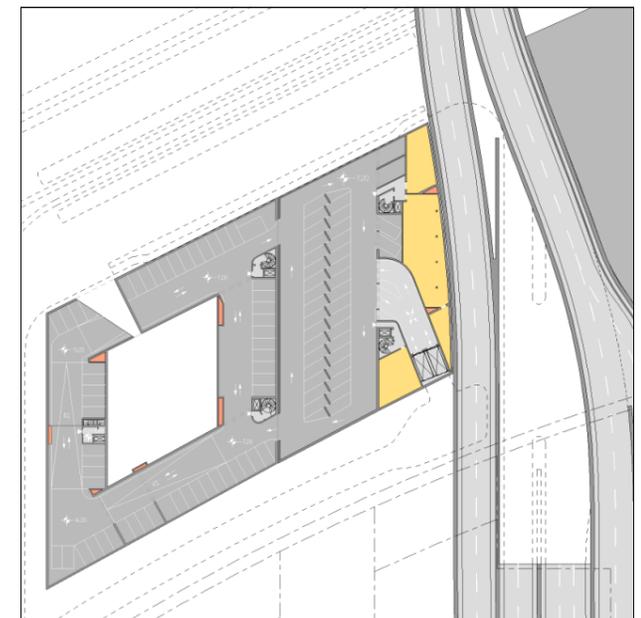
TG Variante 3 | 2. Untergeschoß
